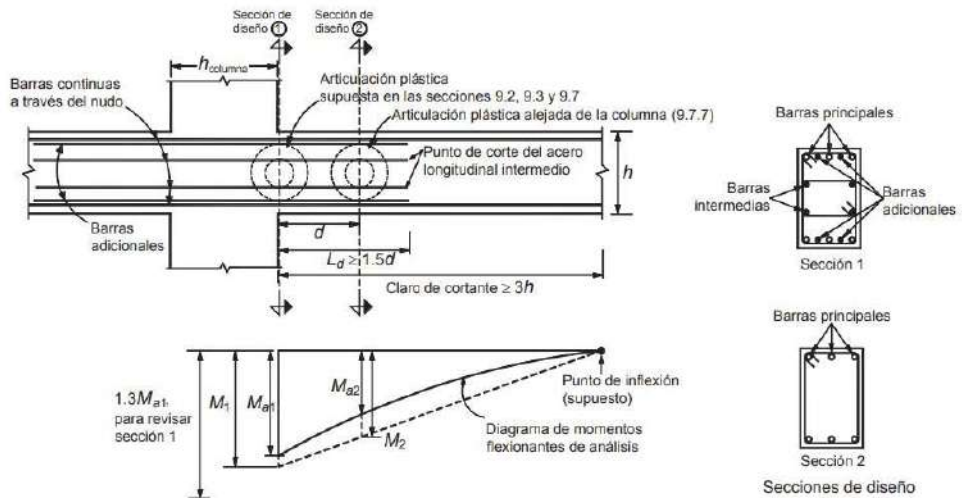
Marcos de alta ductilidad con articulaciones plásticas alejadas de la cara de la columna
